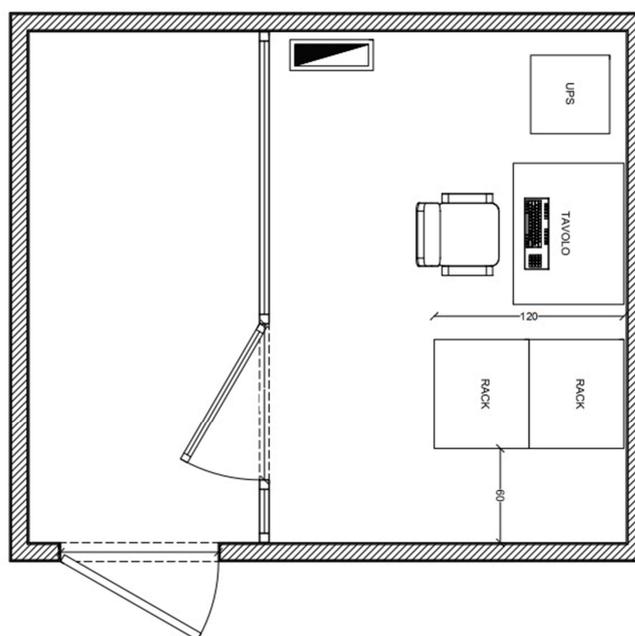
Pianta del locale in muratura con attuale allestimento interno
